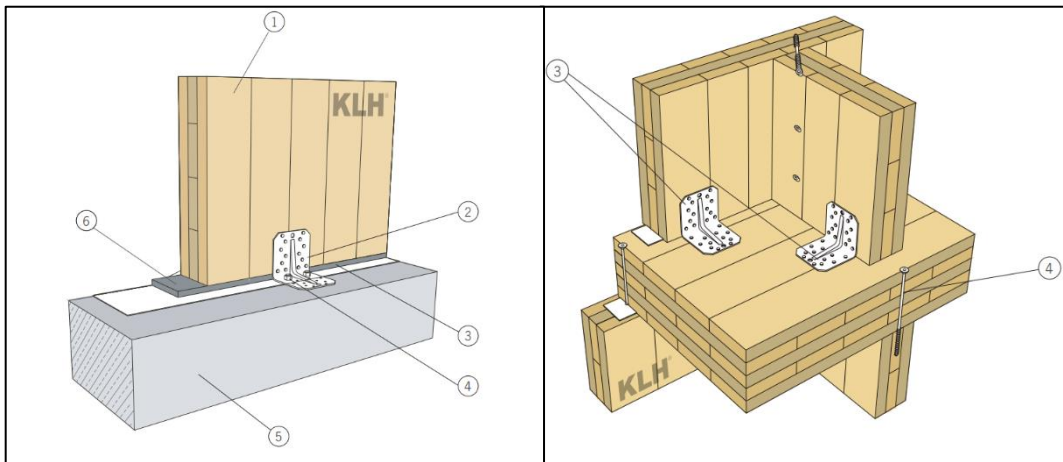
Exemplos de fixações mecânicas do CLT [5]
